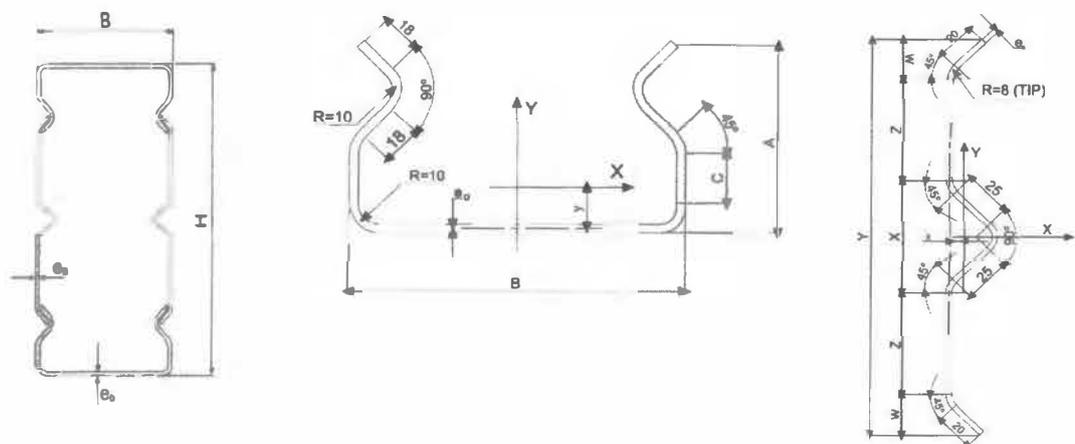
SECCIONES DEL PERFIL TUBULAR RECTANGULAR SOLDADO TUBEST, PERFIL TIPO OHM Y PERFIL TIPO SIGMA
